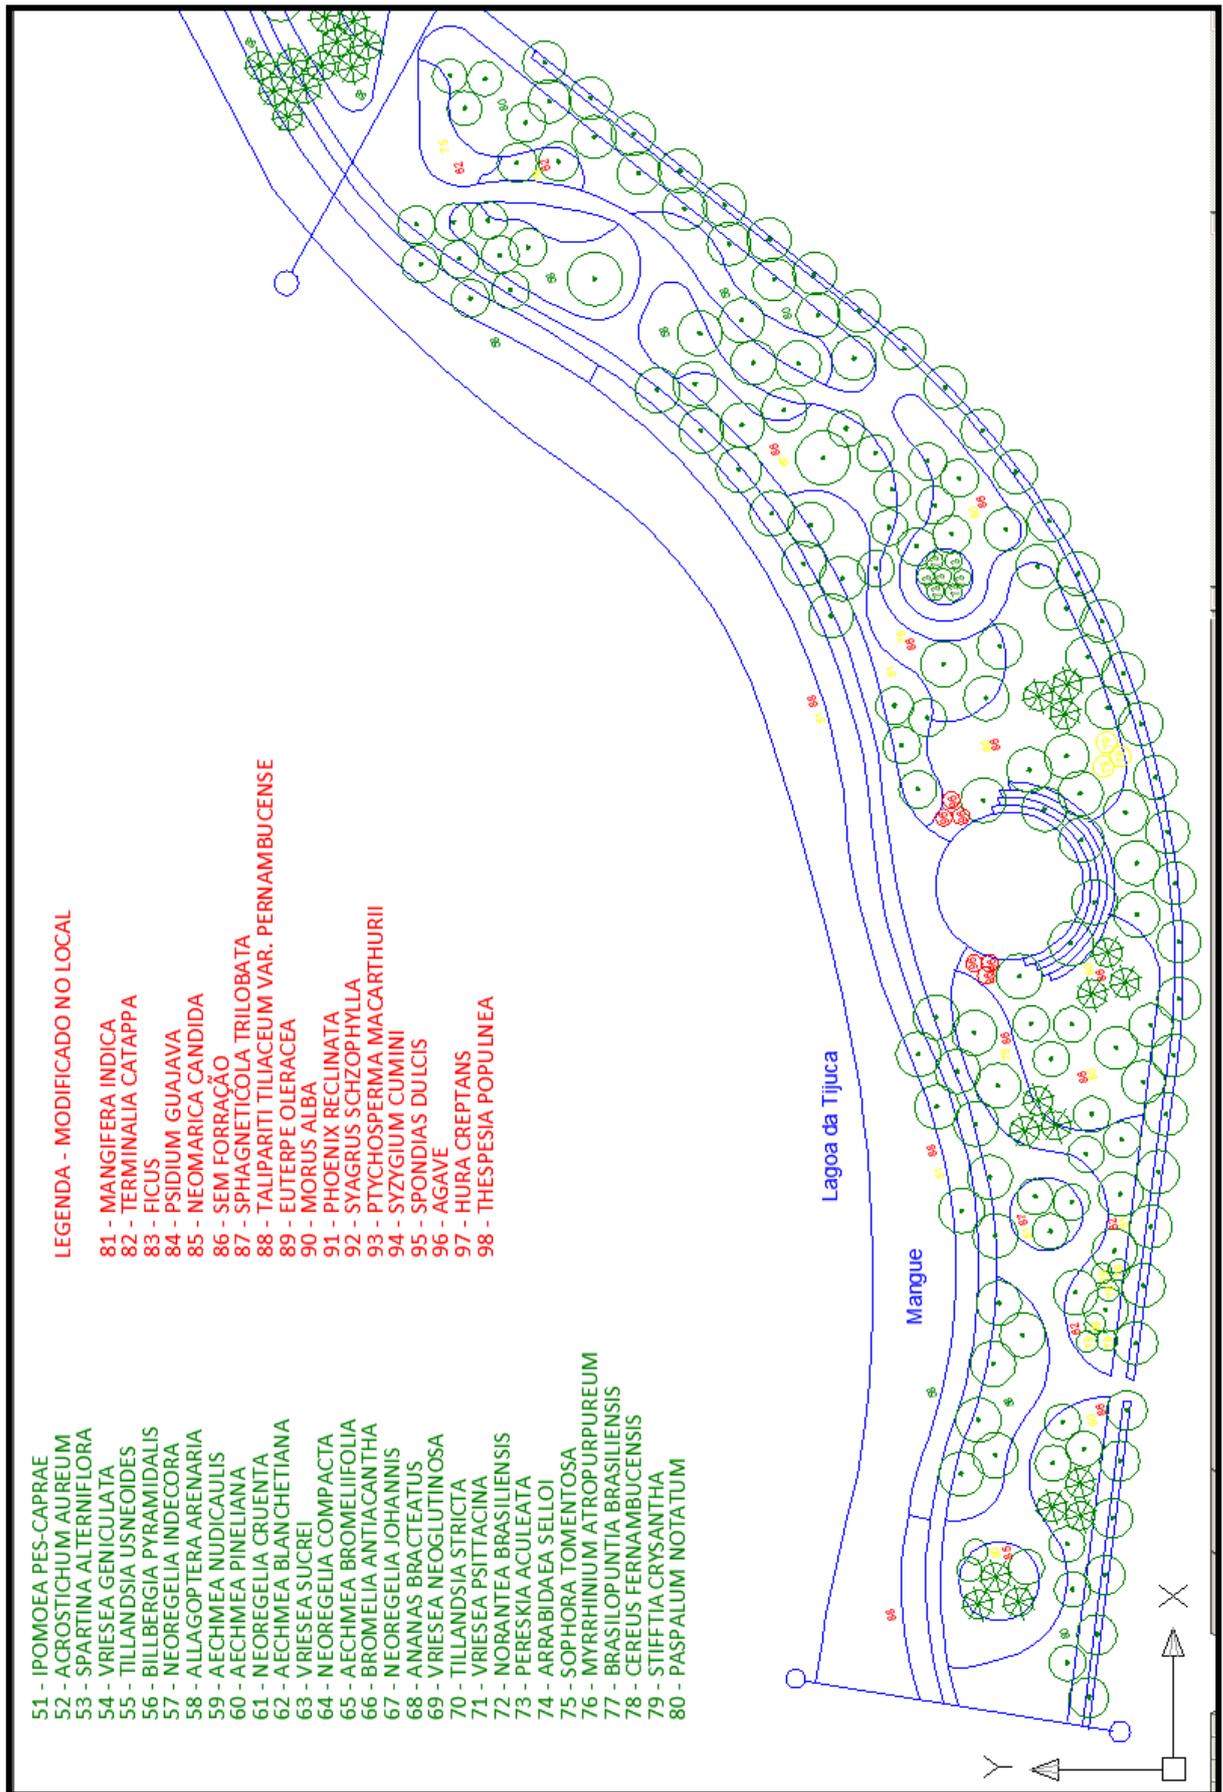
/ Prancha 05 – Planta de Levantamento da Composição Paisagística - cobertura vegetal - autora
